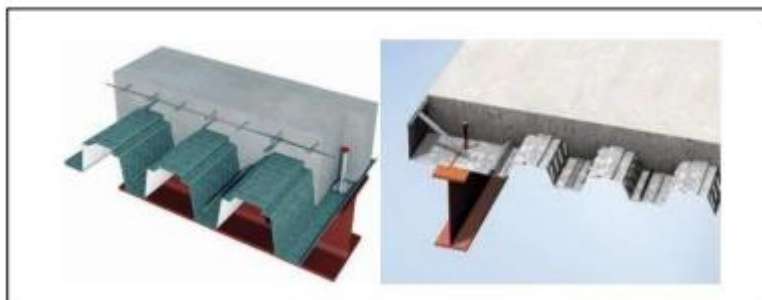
les composants d'une dalle mixte (Plancher Collaborant)
